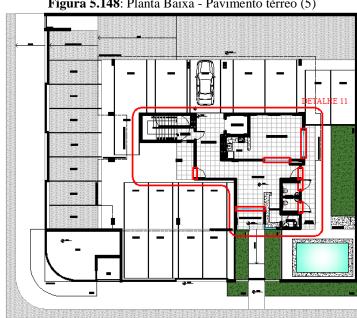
Planta Baixa - Pavimento térreo (5)
